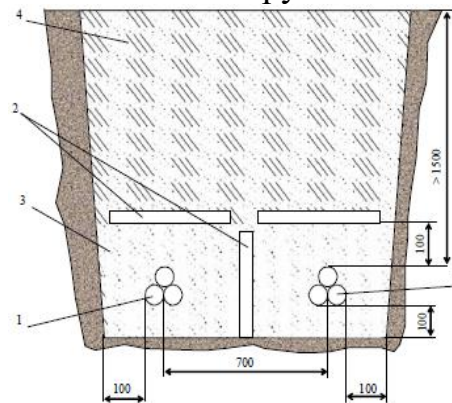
1 - кабель 110 кВ; 2 - залізобетонна плита; 3 - піщано-гравійна суміш; 4 - засипний ґрунт; 5 - кабель 35 кВ
